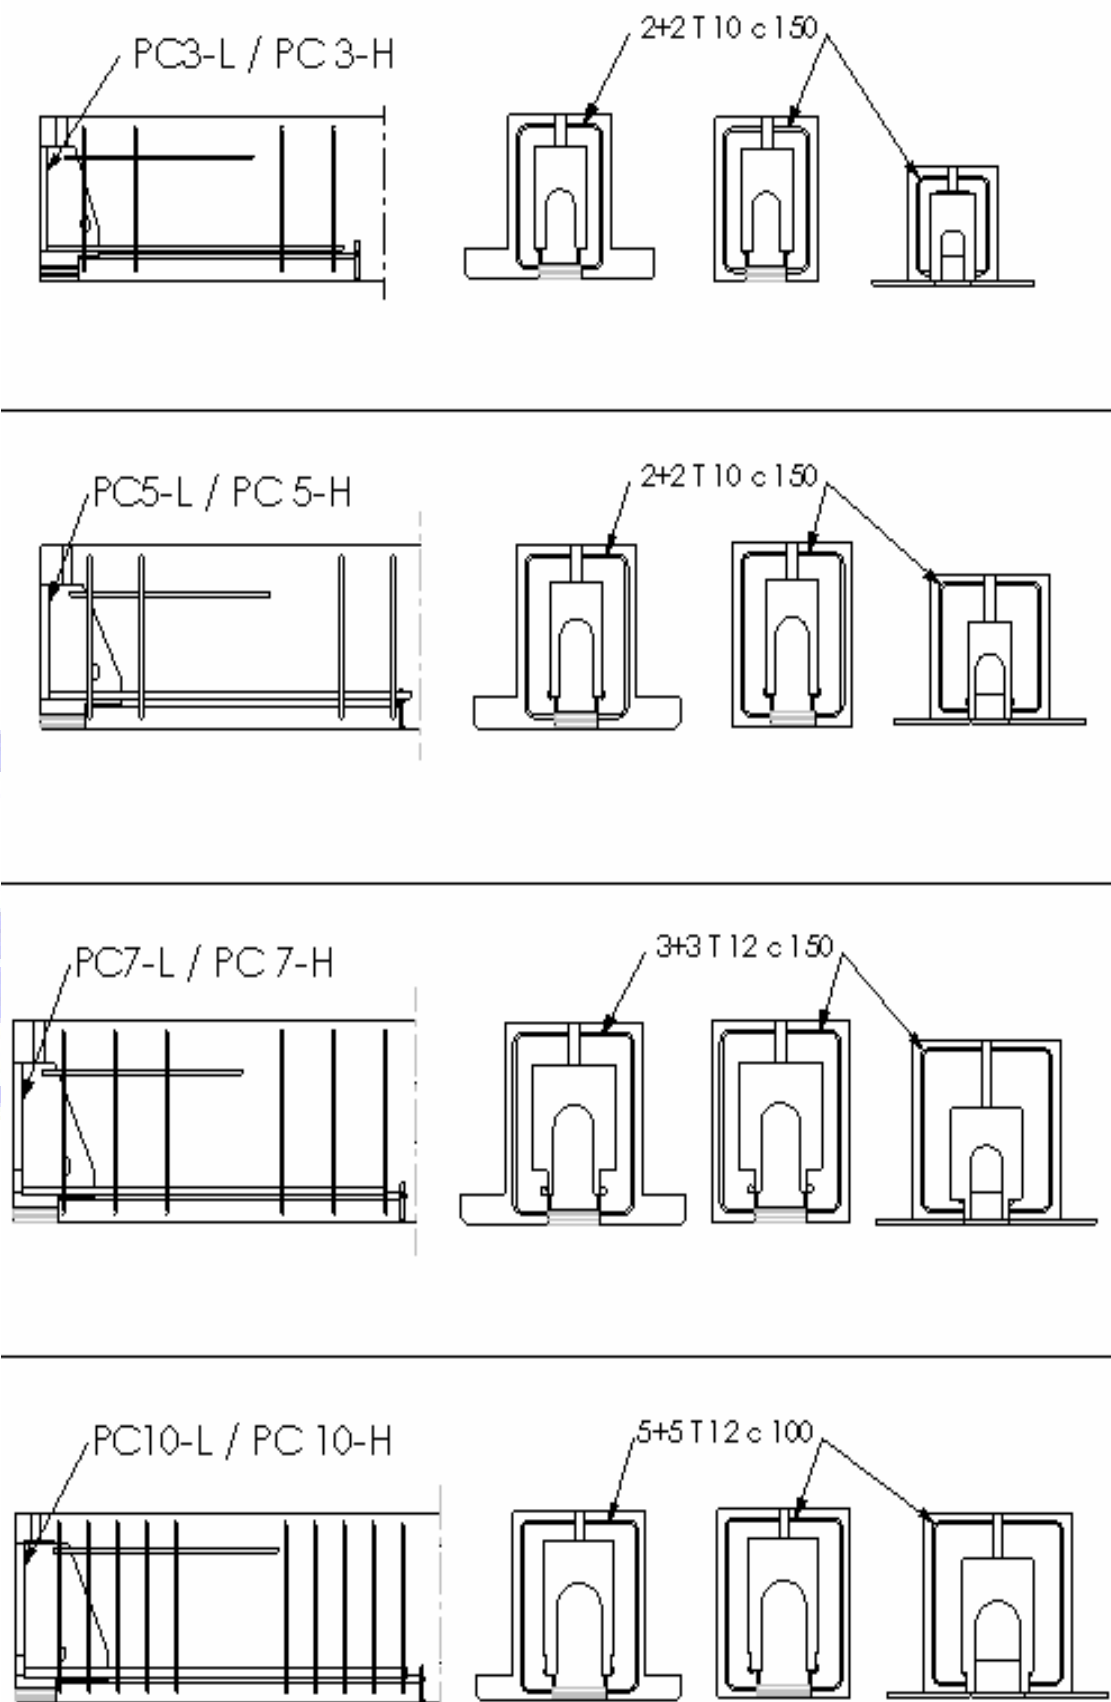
Armadura adicional cuando la separación entre las barras del pie de viga y la armadura principal es ≤ 100 mm.
